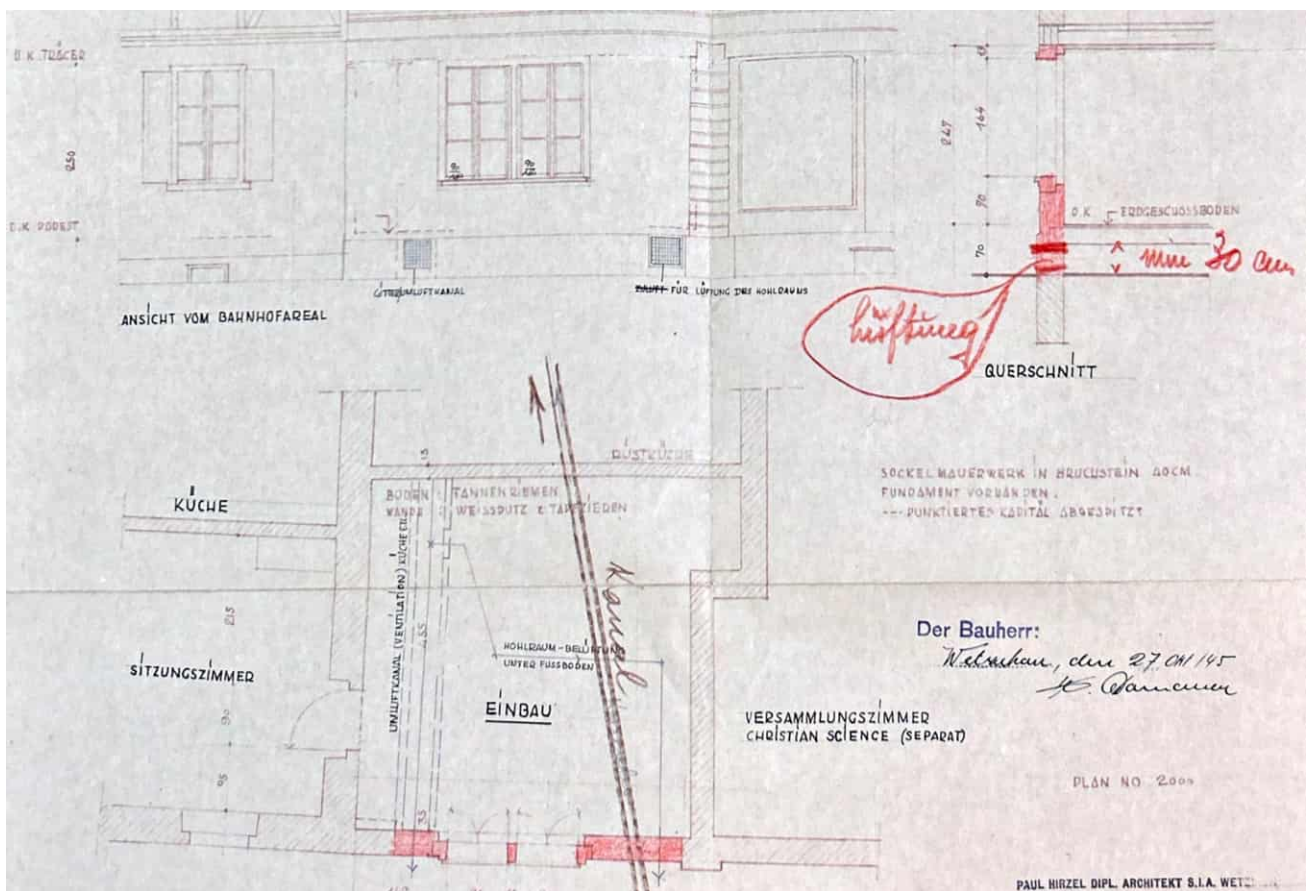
Umbauplan 1945: Einbau Zimmer in Durchfahrt, Architekt Paul Hirzel.
